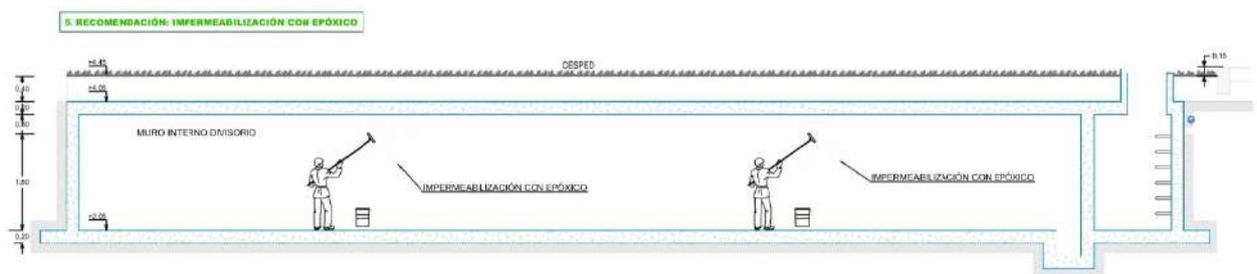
Paso 5. Recomendación. Impermeabilización con epóxico
